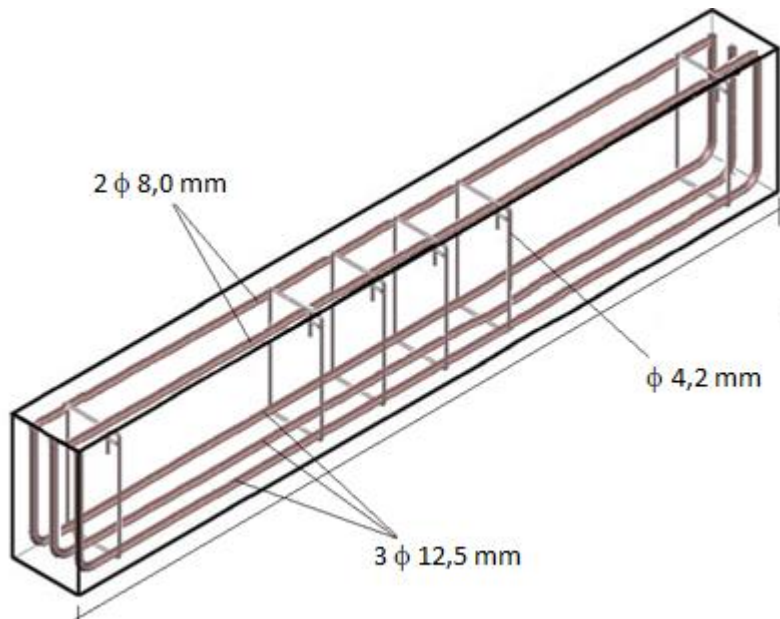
Vista tridimensional das armaduras das Vigas 5 para $a = 67,5$ cm.
